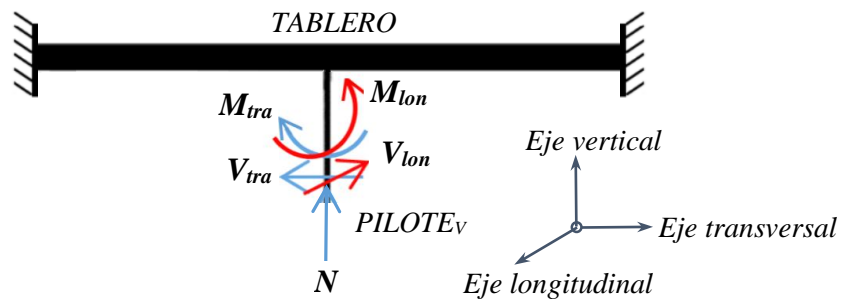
Sistema de sollicitaciones y apoyos para el modelo de conexión con pilote vertical.
